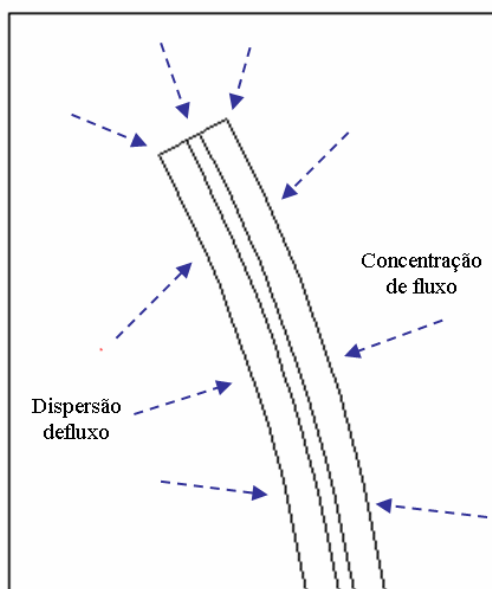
Vista em planta do fluxo de água para a geometria da estação galeria.
